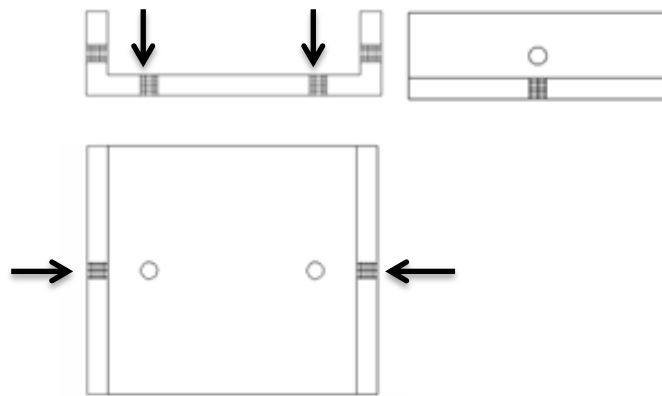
Placa metálica que fixa a estrutura de madeira ao chão
